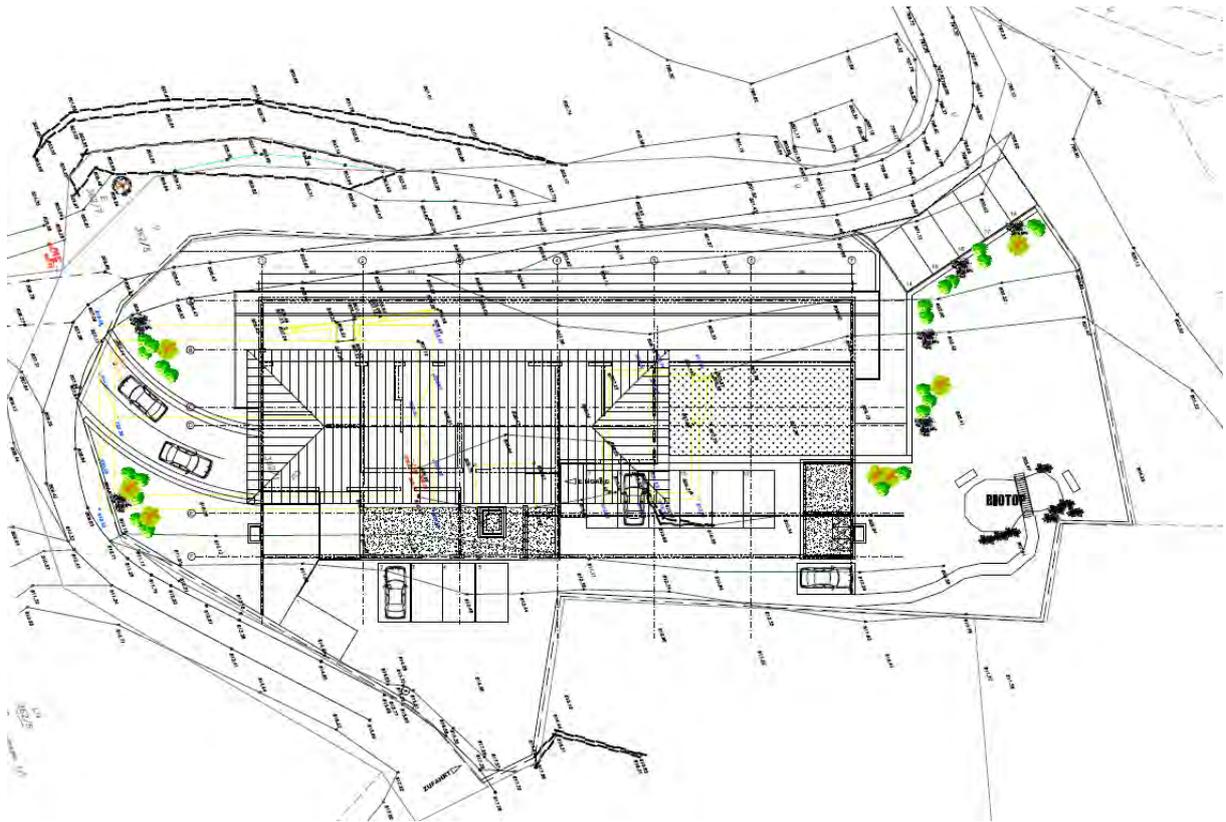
Lageplan Architektur (Quelle: Architekturbüro Lengger)
